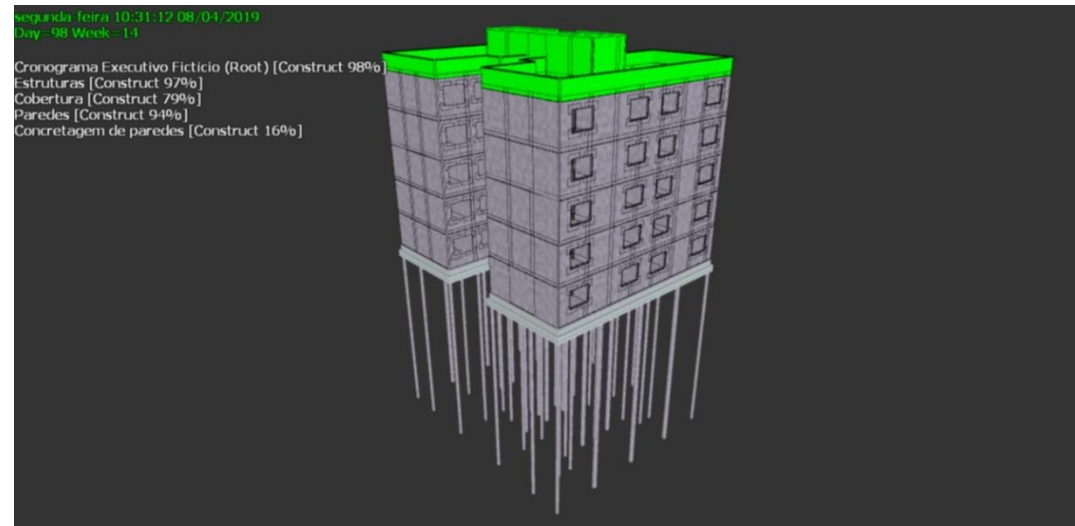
Concretagem em andamento das paredes da cobertura.
